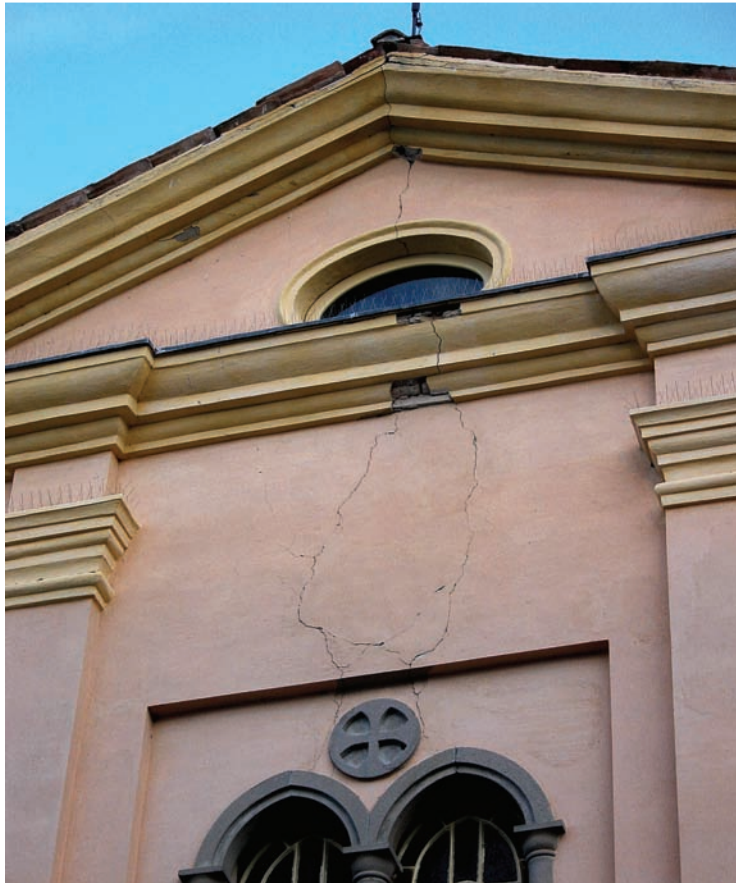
Sant'Ilario Baganza (Felino), chiesa: lesioni sulla facciata.
